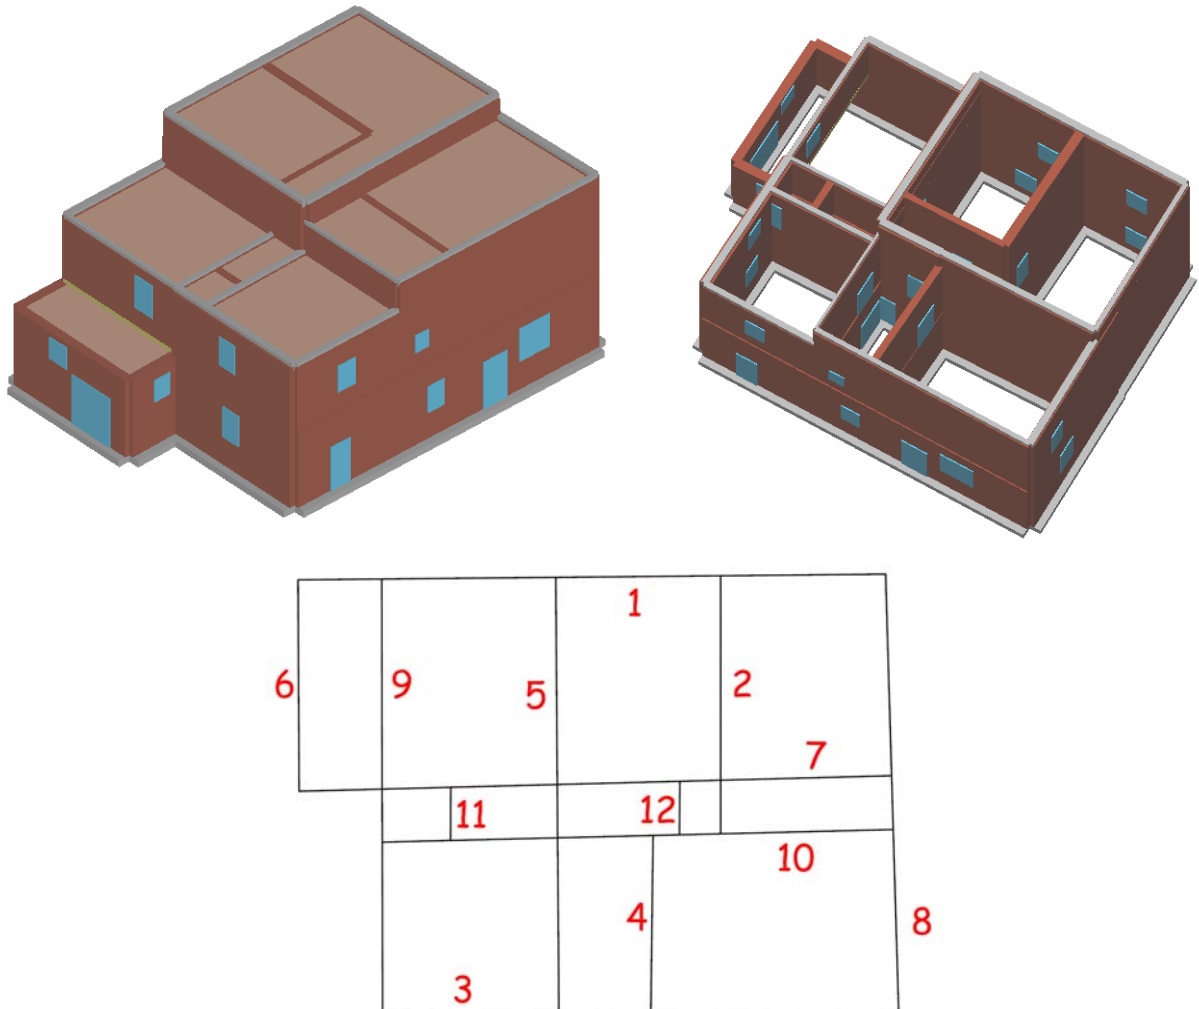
Viste 3D del modello e pianta con la numerazione delle pareti
